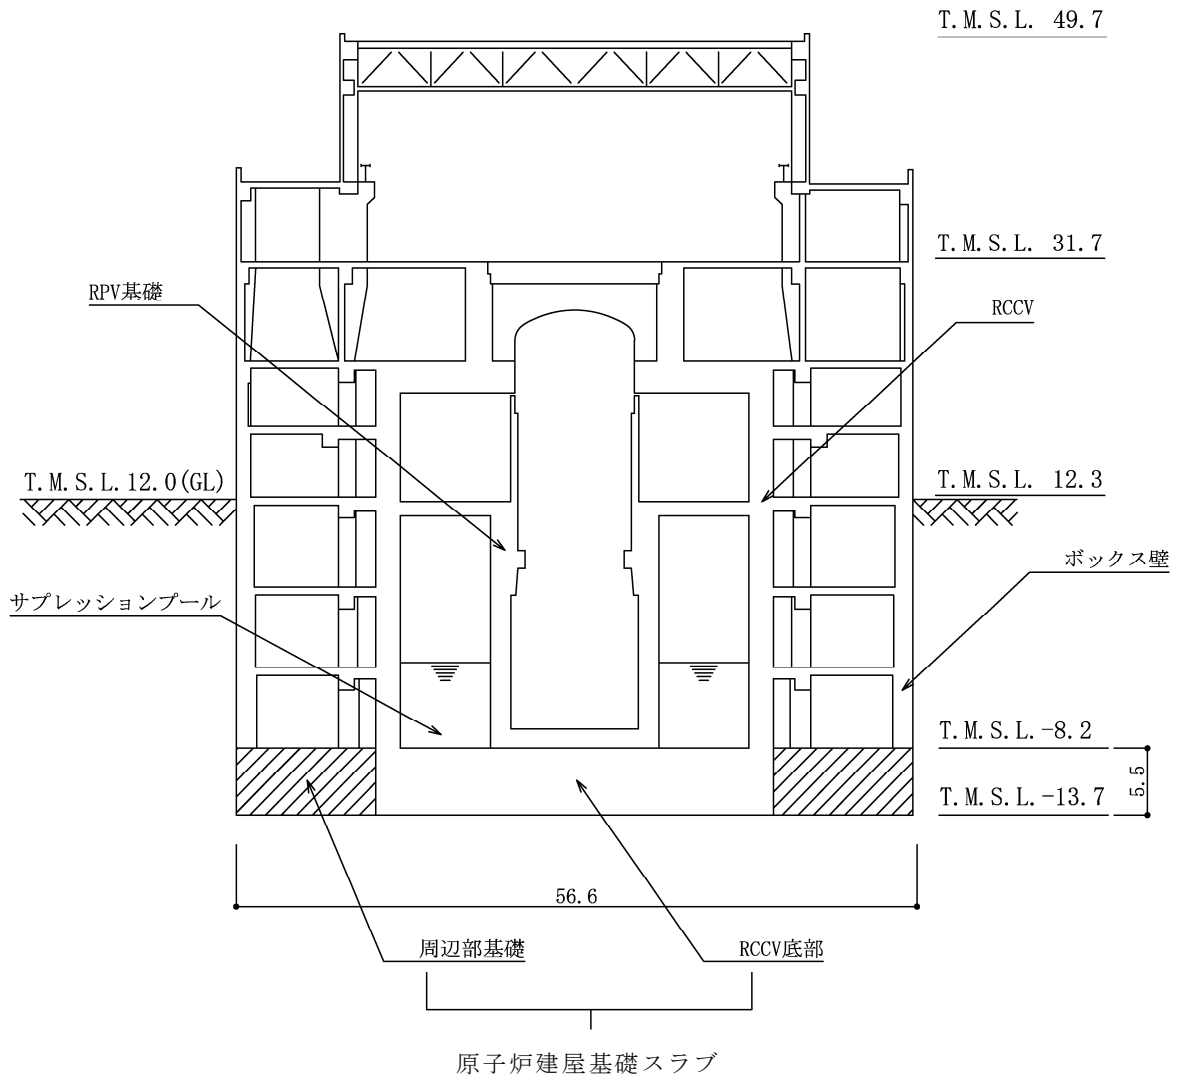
原子炉格納施設の基礎の概略断面図 (A-A 断面) (単位 : m)
